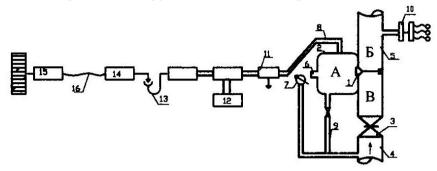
Схема дренчерной автоматической установки: I – золотник; 2 – корпус клапана группового действия; 3 – главная задвижка; 4 – водопитатель; 5 – дренчерная магистраль; 6 – пробка; 7 – манометр; 8 – побудительный трубопровод; 9 – диафрагма; 10 – контактный выключатель побудительных устройств; 11 – спринклер; 12 – побудительный кран; 13 – побудительный клапан; 14 – легкоплавкий замок; 15 – натяжное устройство; 16 – трос
